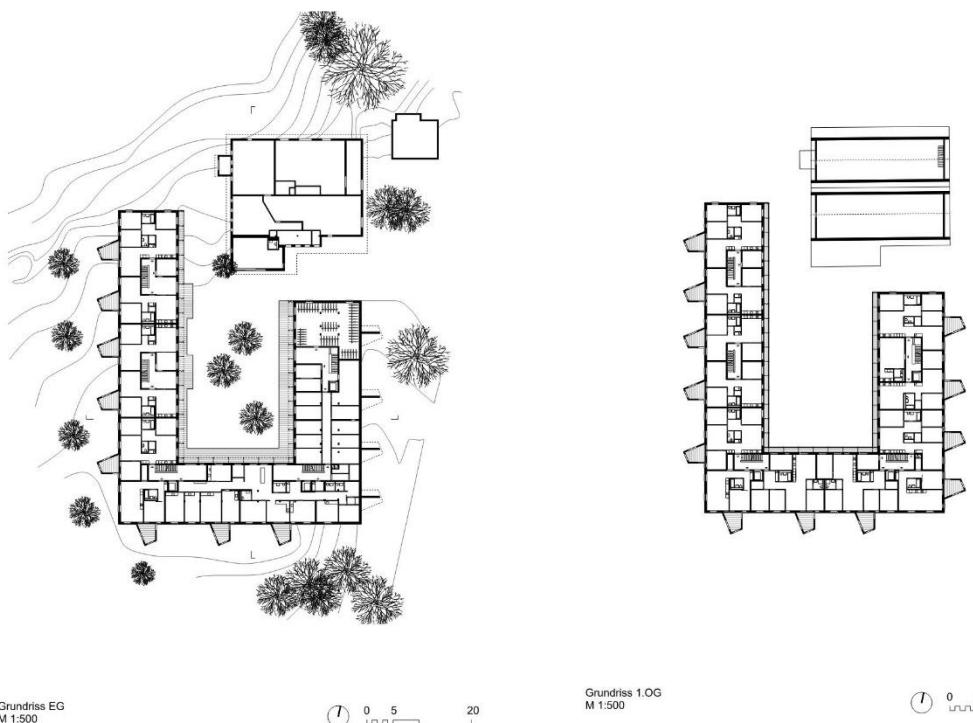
Grundriss EG und Regelgeschoss – aus ökologischen Gründen wird auf eine Tiefgarage verzichtet
